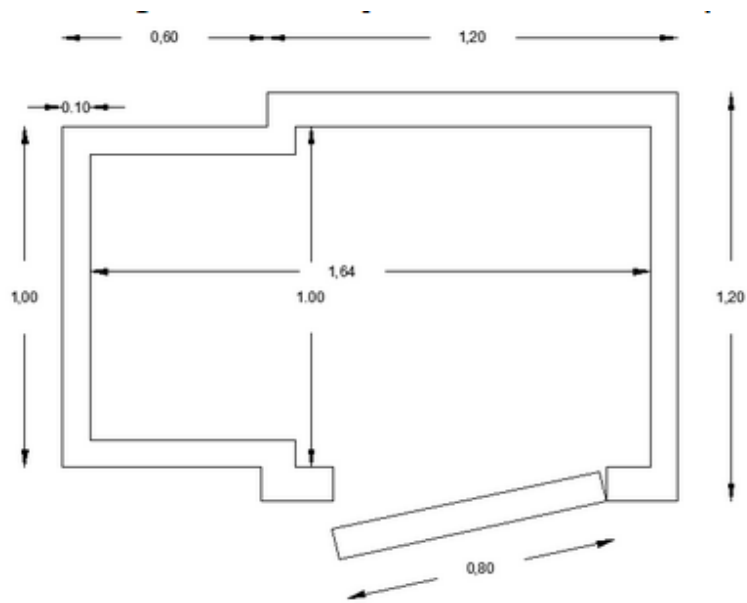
Vista en planta de la cámara de ensayo, Fuente: Elaboración Propia
